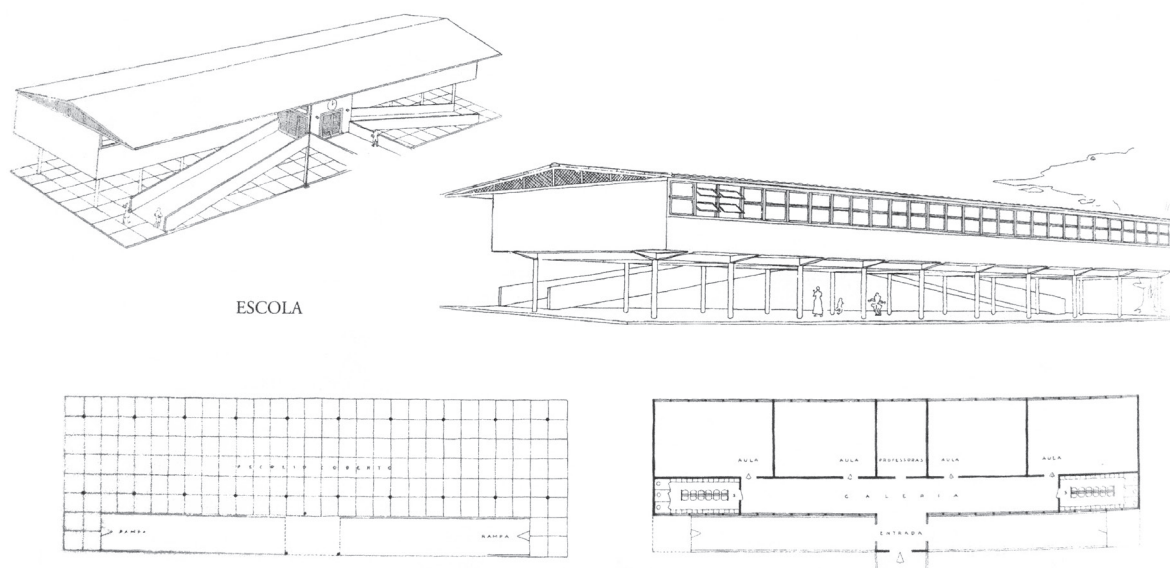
Planta dos pavimentos térreo e superior da escola. Perspectiva da escola.
